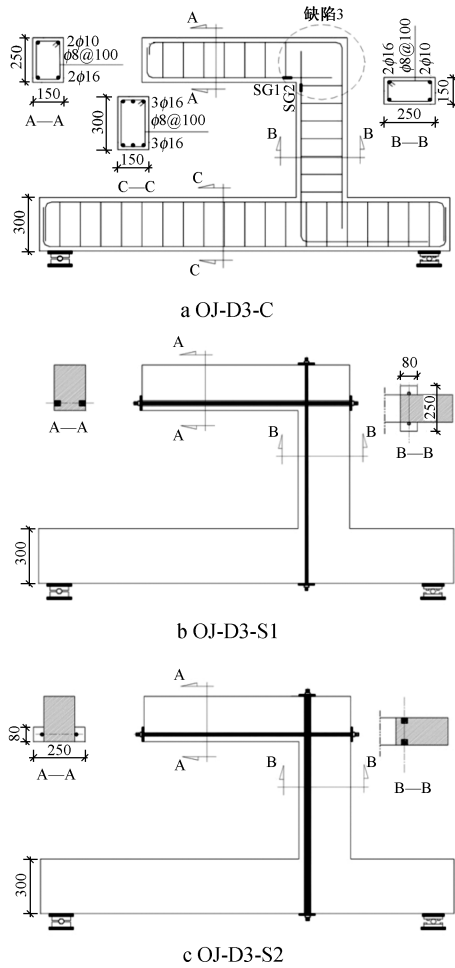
第 4 组试样的混凝土尺寸和钢筋细节
